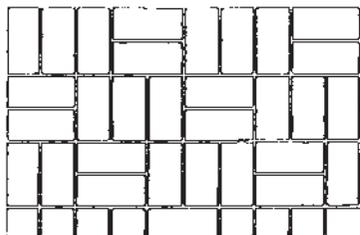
Alternativamente cada dos o tres adoquines cerámicos en sentido cambiante colocados a tizón (planos).
